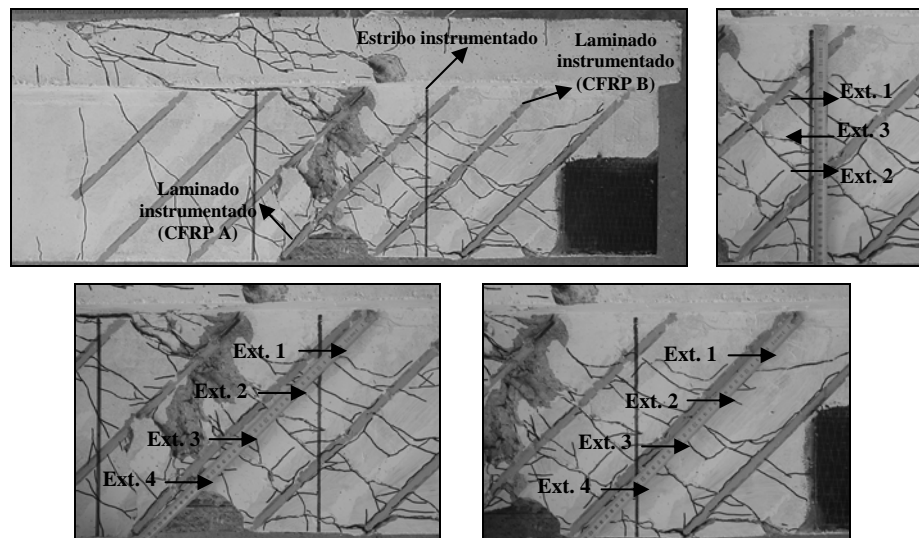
Localização dos extensômetros no laminado e estribo instrumentados da viga 2S-7LI45-B.
